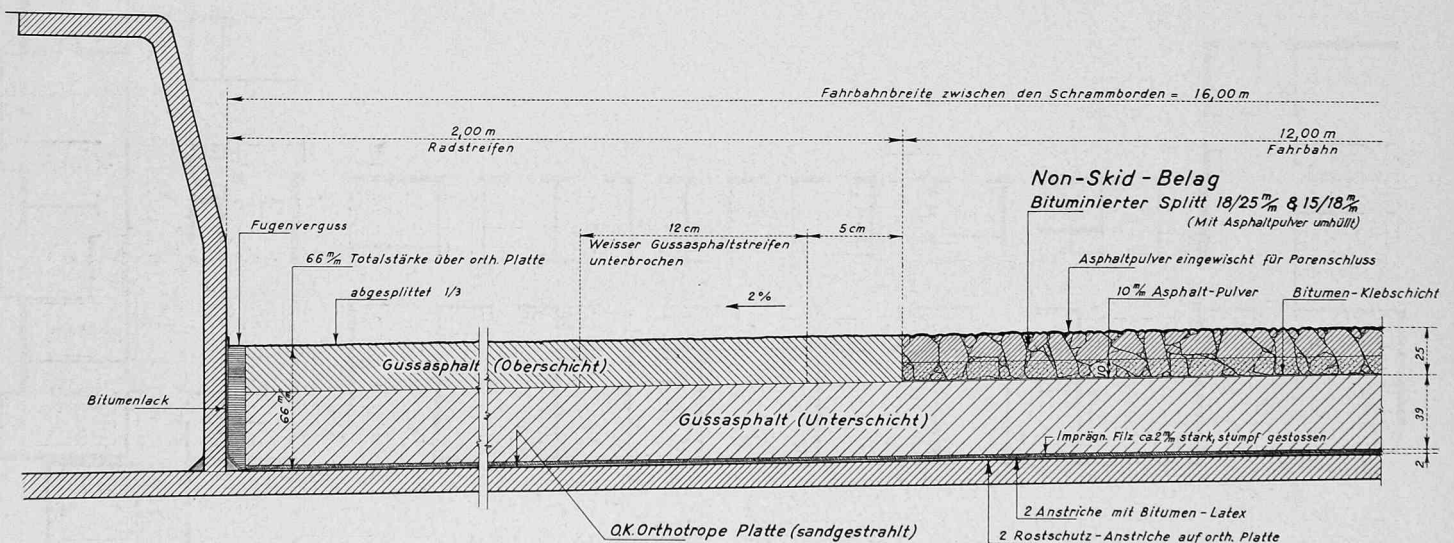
Aufbau des ursprünglichen Fahrbahnbelages auf der St.-Alban-Brücke, Massstab 1:4
